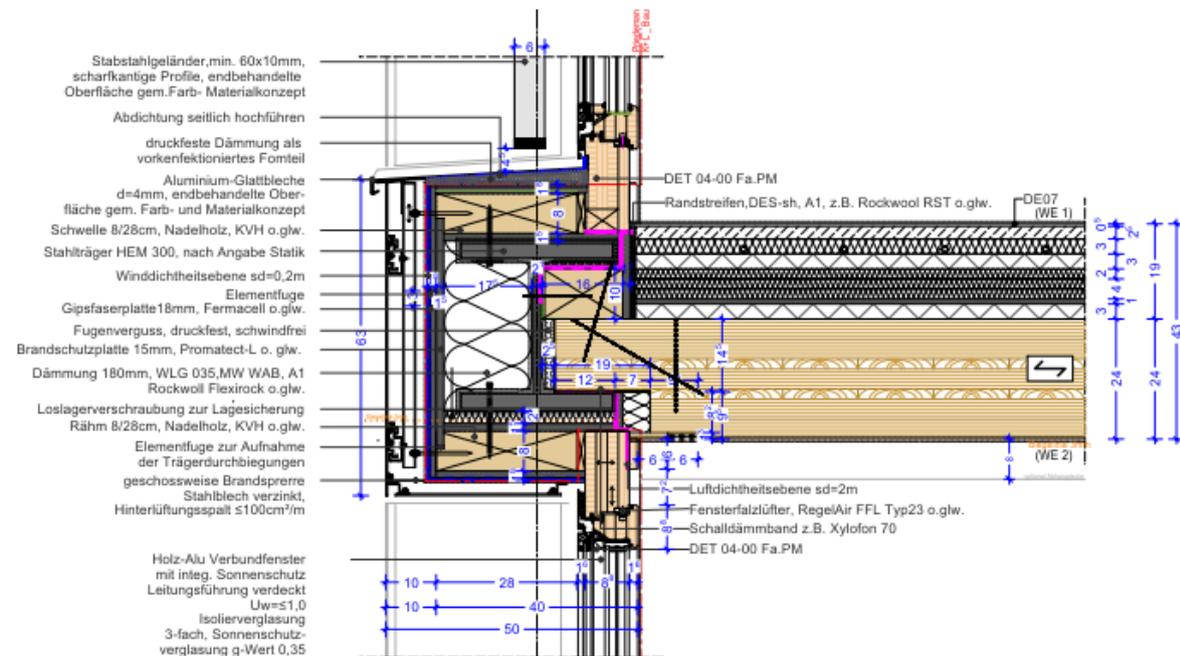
Detail Aussenwand/Decke (Quelle: Kaden und Lager, Berlin)
